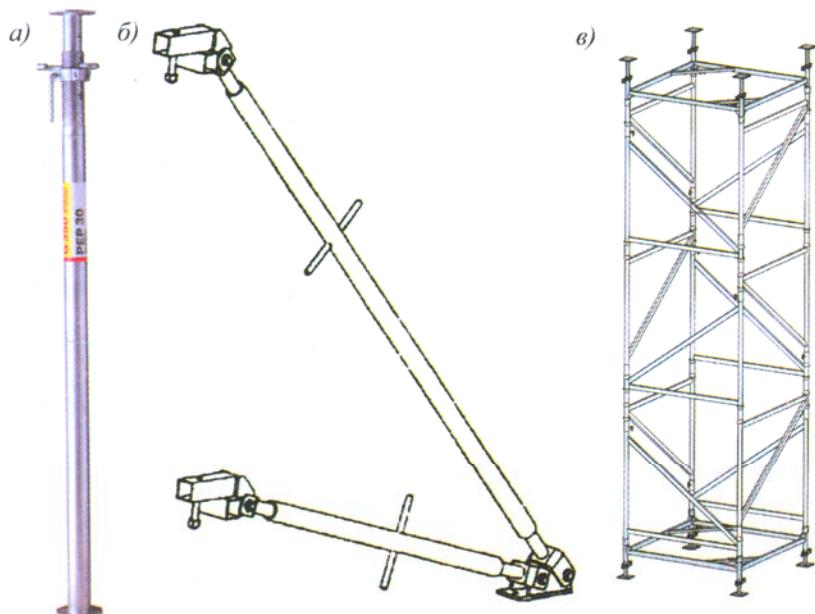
Опоры: а - стальные стойки фирмы PERI; б - подкос монтажный; в - рамная опора фирмы HOE
